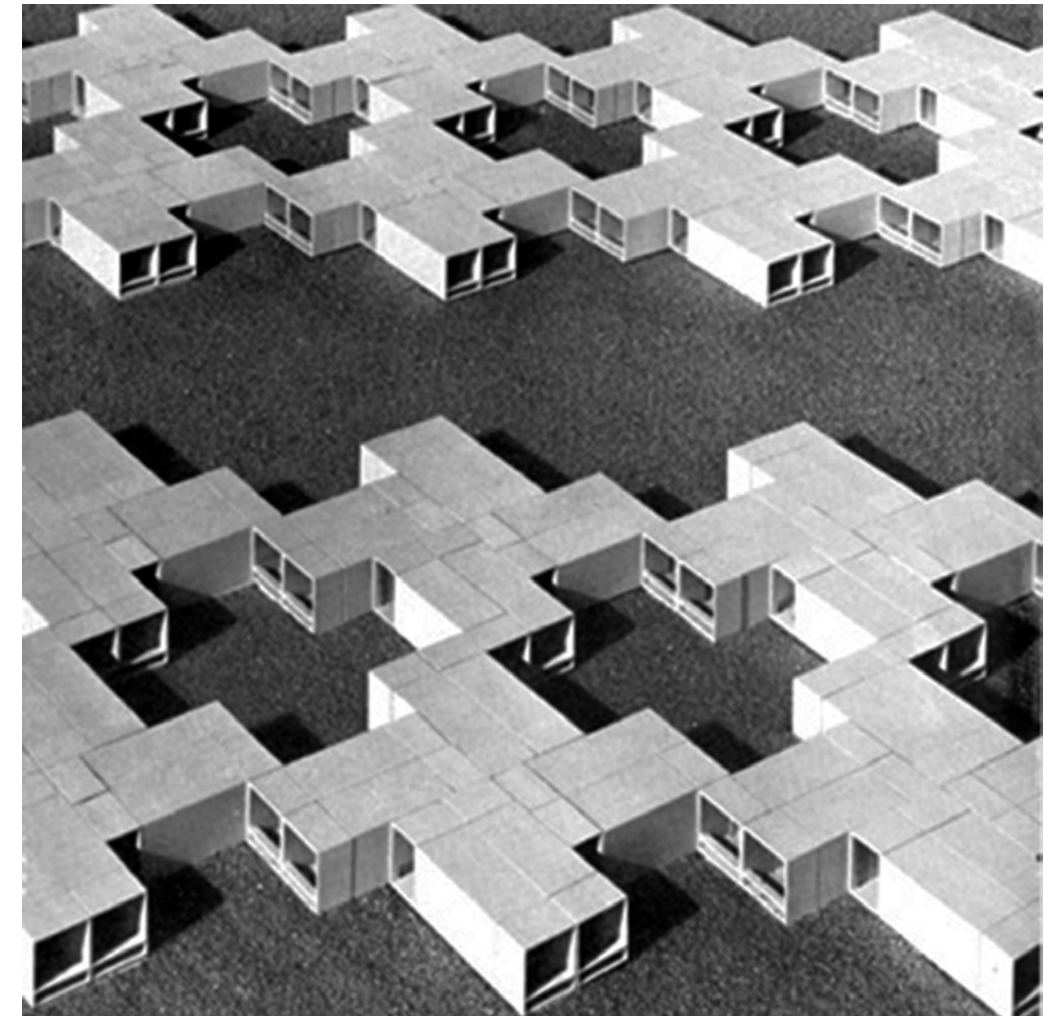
Instituto para la construcción industrializada. Sistema de viviendas prefabricadas, 1961. Foto: Archivo HfG Ulm.
